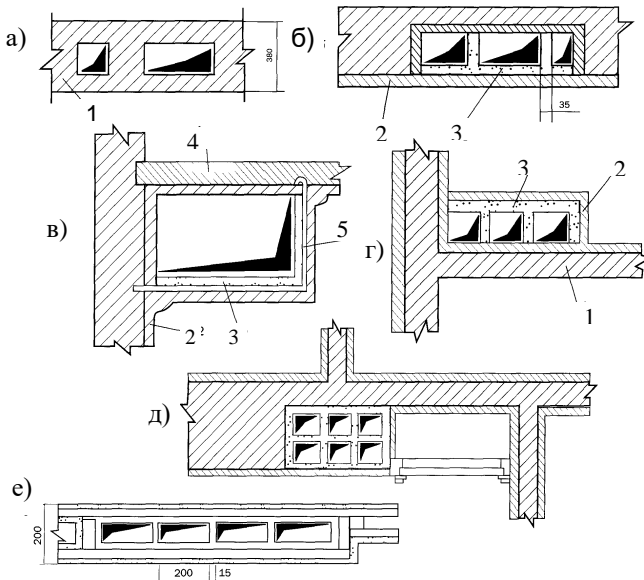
Конструкции вентиляционных каналов: *а* – в кирпичной стене; *б* – в борозде стены, заделываемой плитой; *в* – подвесного, горизонтального; *г-д* – приставных (пристенных) вертикальных; *е* – из сухой штукатурки в перегородке; 1 – кирпичная стена; 2 – штукатурка; 3 – шлакогипсовые плиты; 4 – перекрытие; 5 – подвеска стальная, $d = 6$ мм
